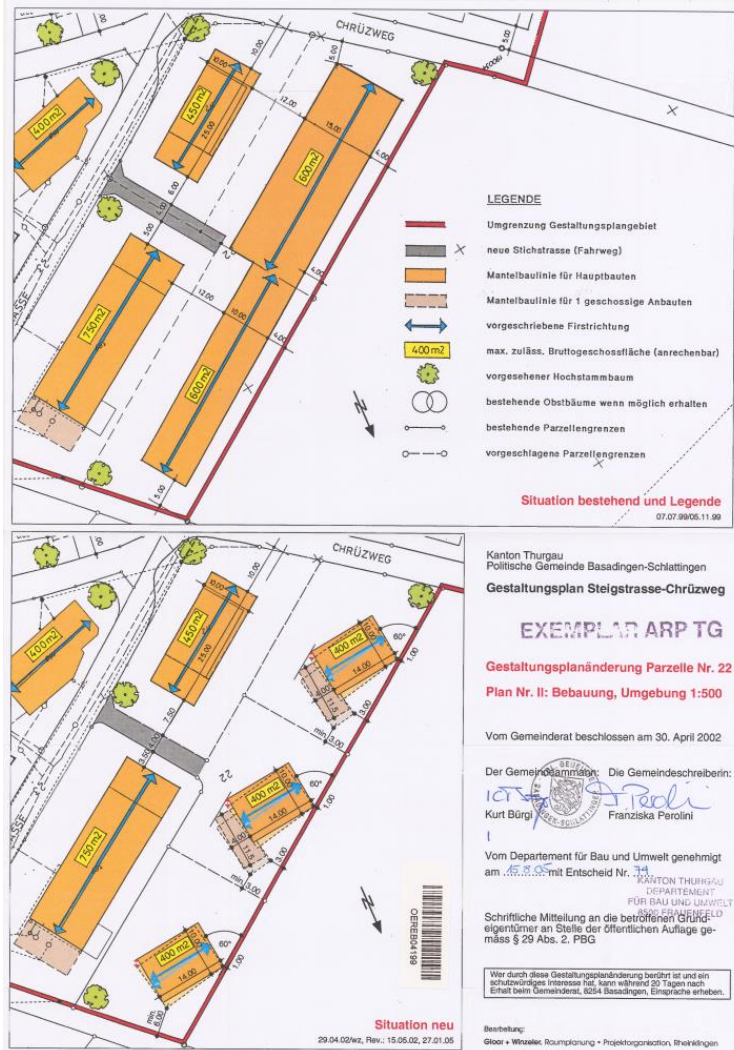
Ausschnitt Teiländerungsplan 2005
